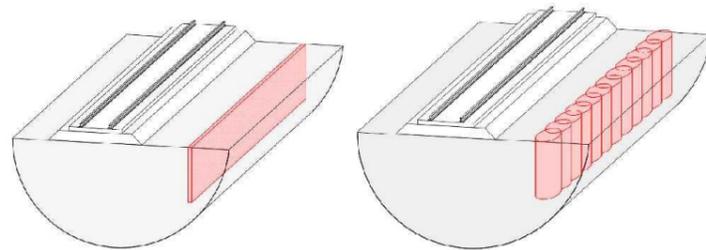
Représentation schématique d'une tranchée antivibratile (gauche) et d'une injection de béton par Jet Grounding (droite).
